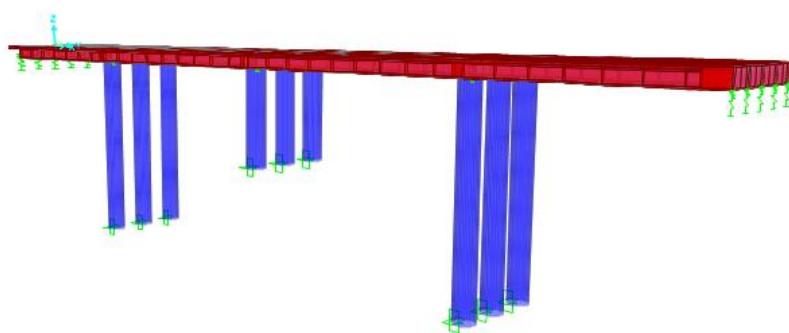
Puente en Vista de Elevación 2 (Fuente: elaboración propia)
